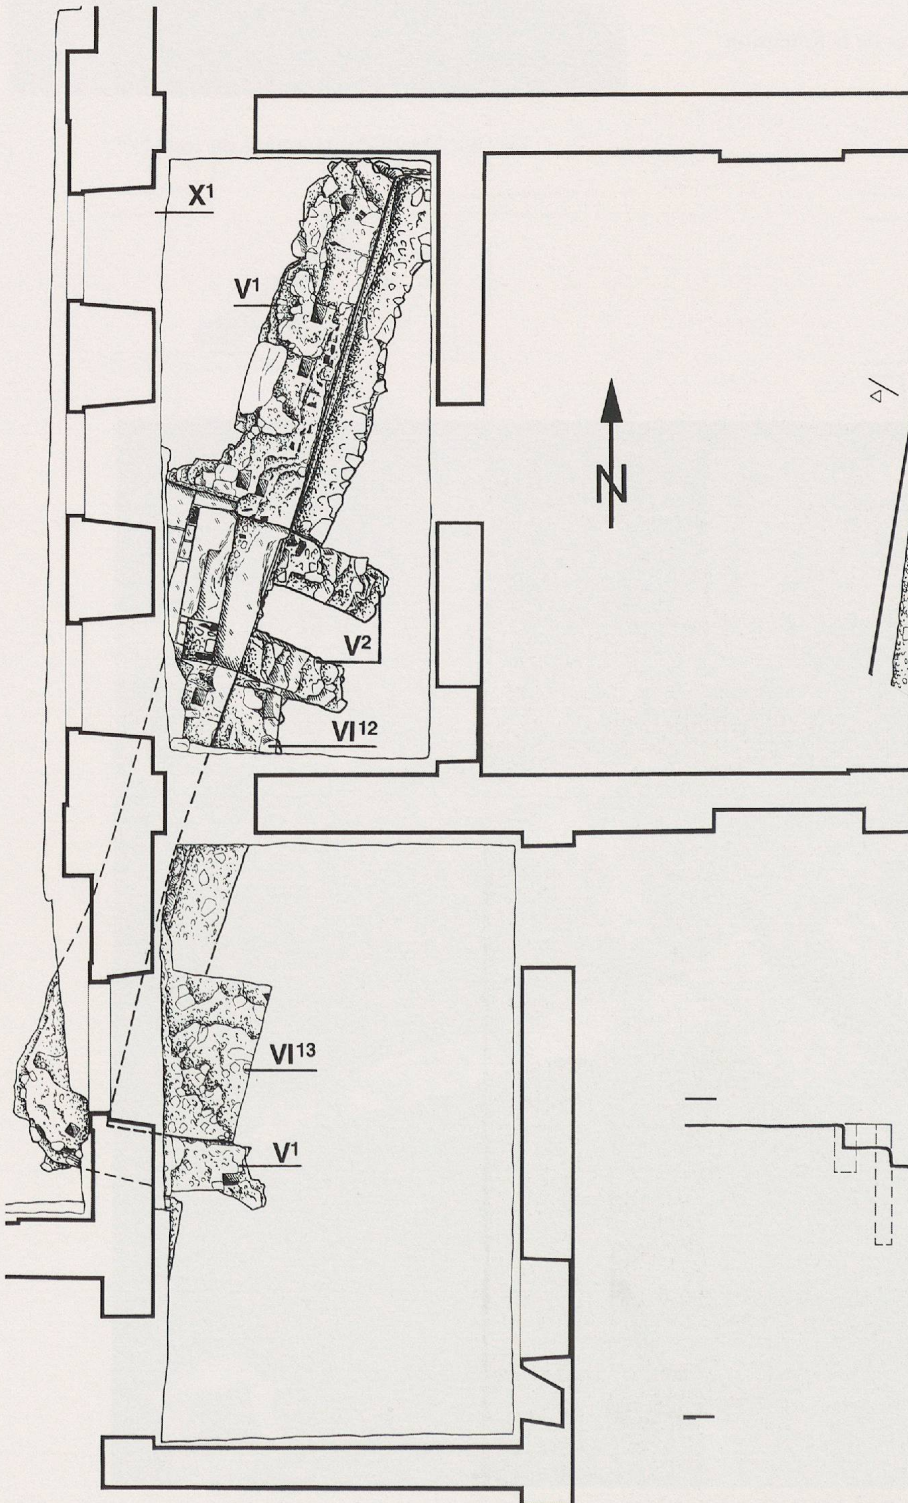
Plan de détail de l'ancienne cave sous le corps central du château (éch. 1:100).
